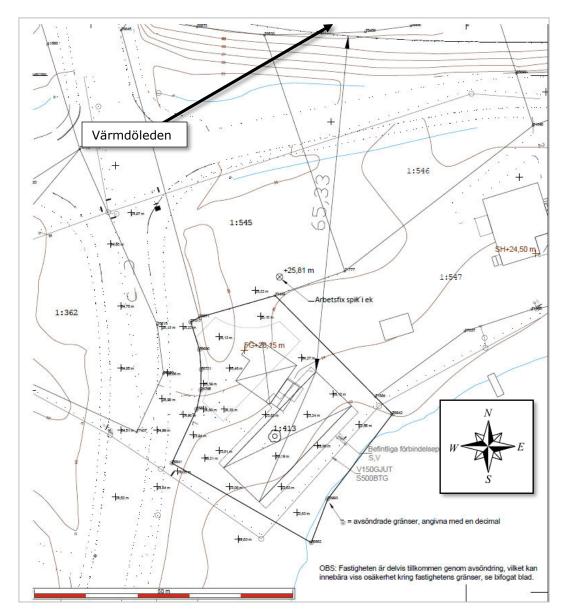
Situationsplan för den planerade bebyggelsen inom Björknäs 1:413 [7]
